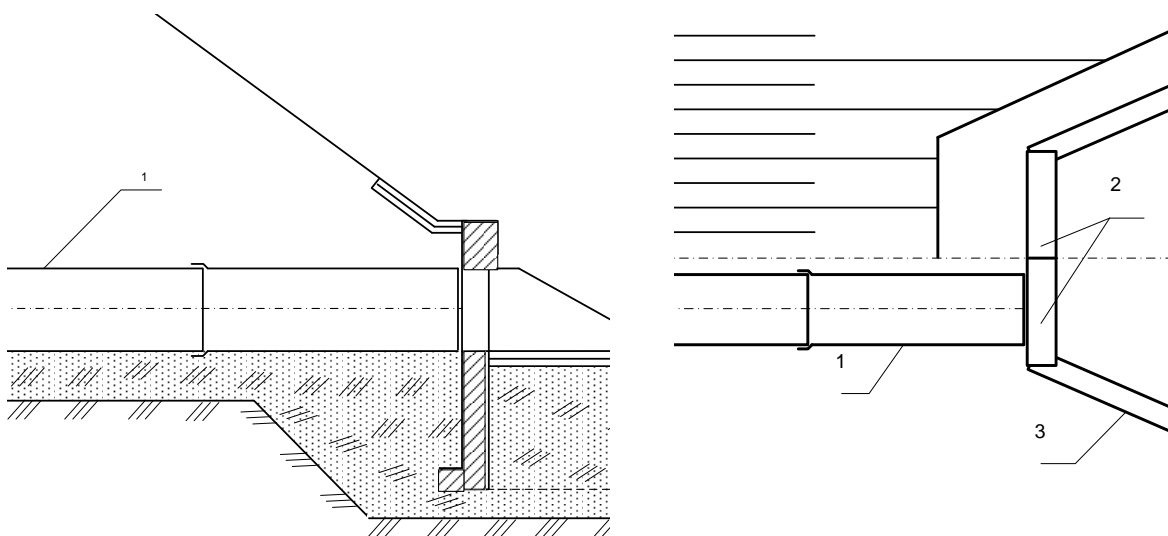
Раструбный оголовок: а) продольный разрез трубы; б) план : 1- звено трубы; 2 – порталая стенка; 3 – откосные крылья.
